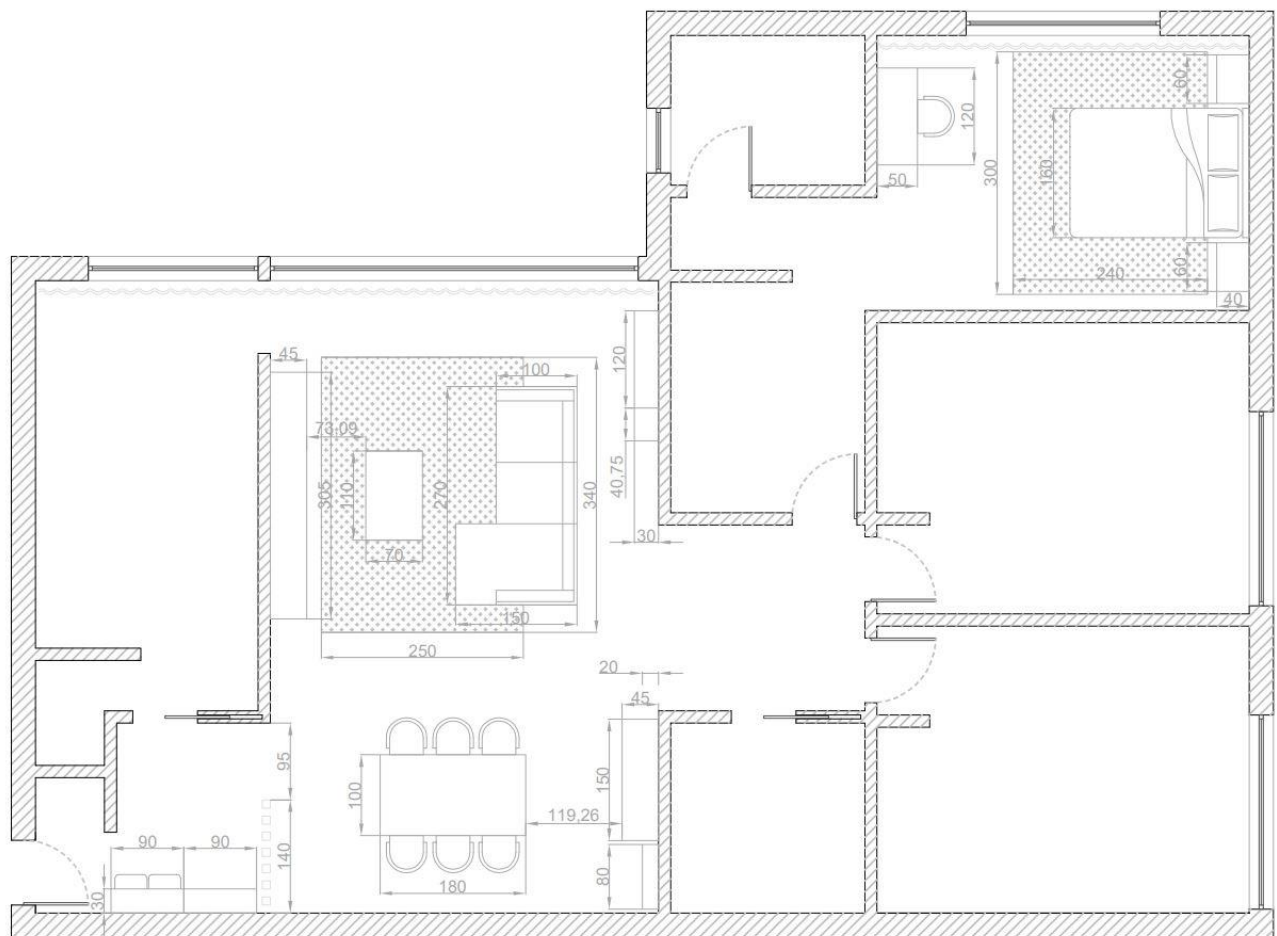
Planta de Equipamento Cotada do Projeto Joana C.
